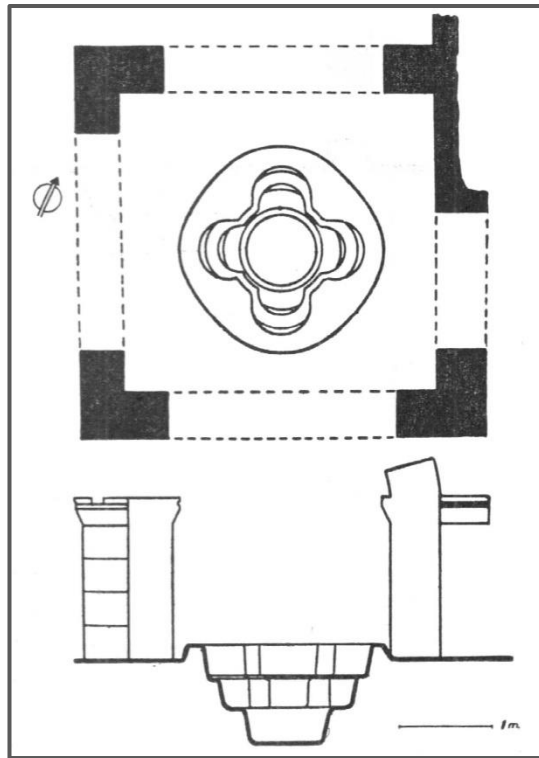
Demna 1. Planimetria e sezione del fonte battesimale, fase II (Khatchatrian 1962, fig. 279).
